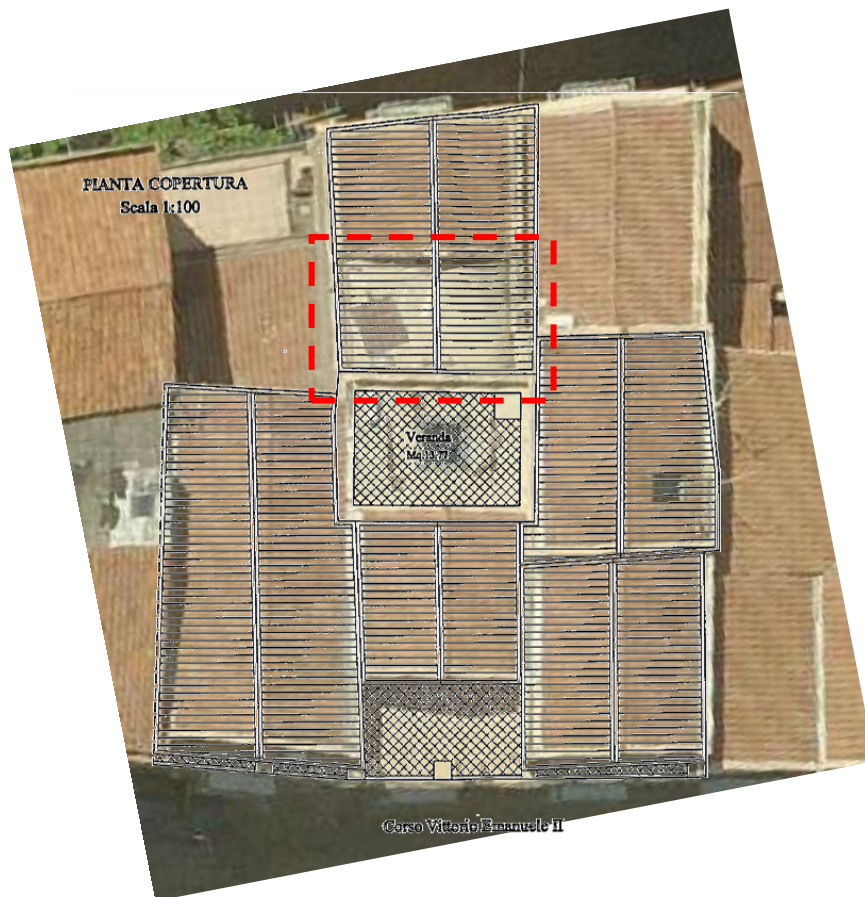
Sovrapposizione ortofoto/progetto approvato. Nord in basso
